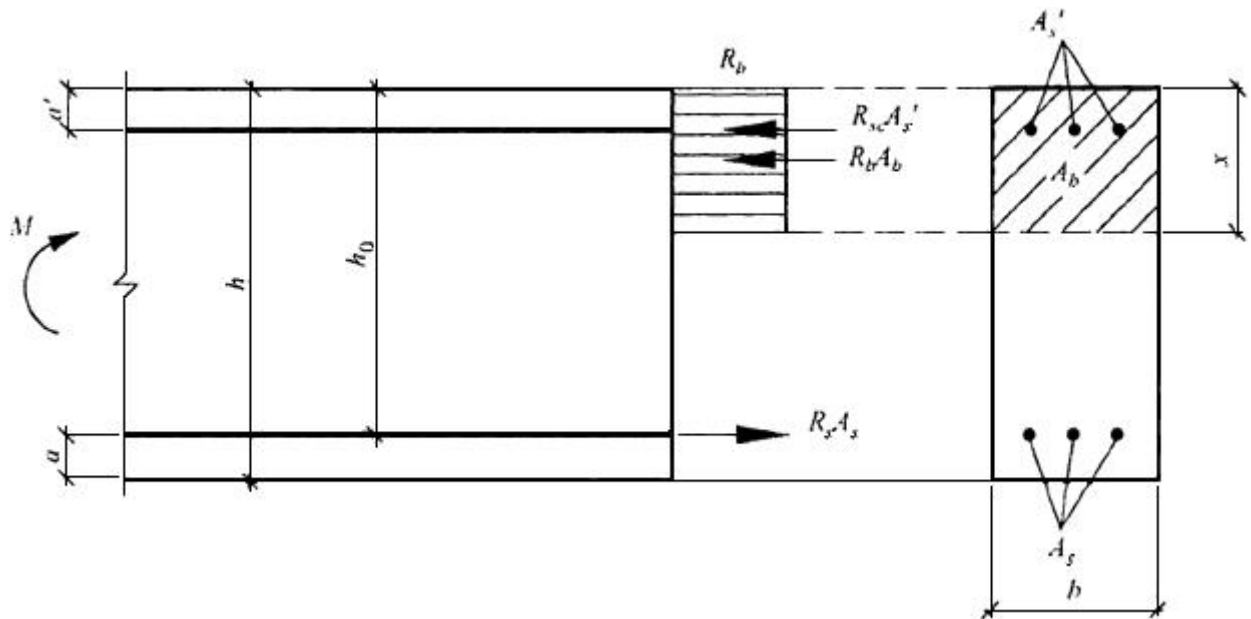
Схема усилий и эпюра напряжений в поперечном прямоугольном сечении плиты перекрытия
